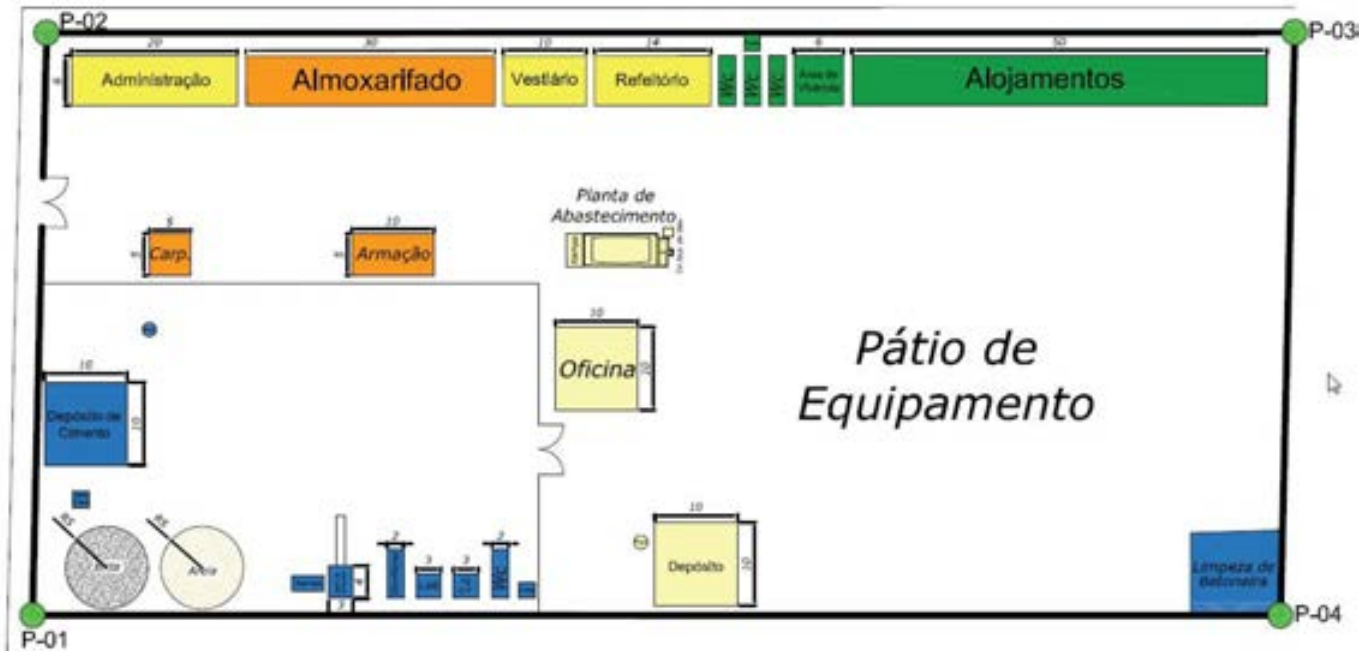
Esquema Ilustrativo das estruturas do canteiro típico de obras de LT.
